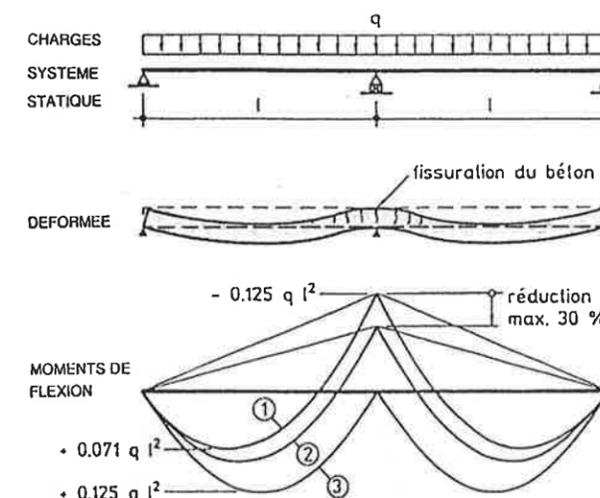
Analyse d'une dalle mixte continue (exemple)
